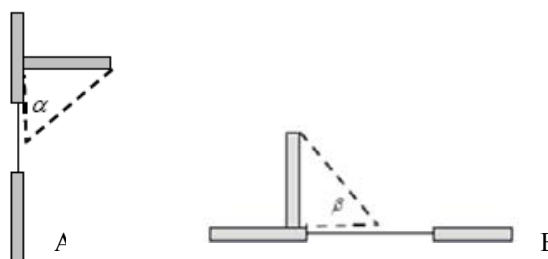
Aggetti orizzontali e verticali (A: sezione verticale; B: sezione orizzontale)
